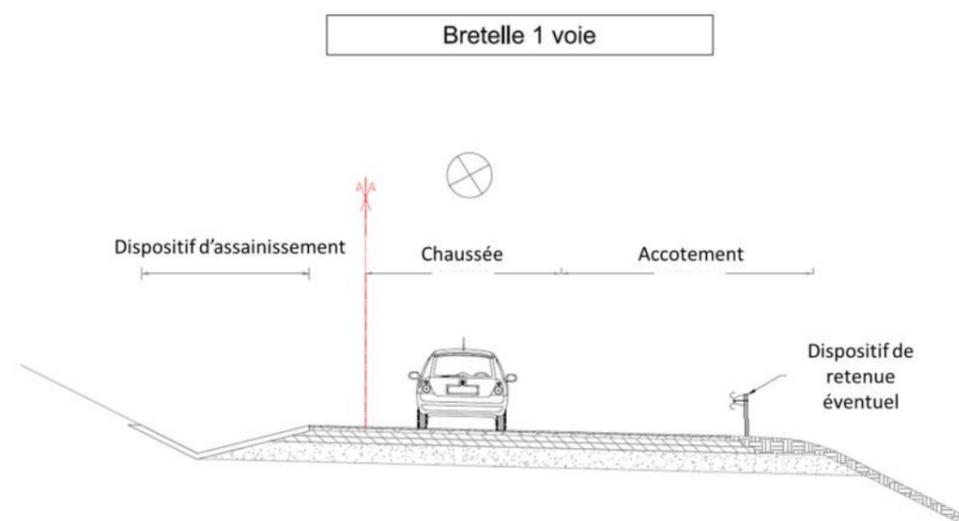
Profil en travers type mis en œuvre sur les bretelles d'entrée et de sortie à une voie.
